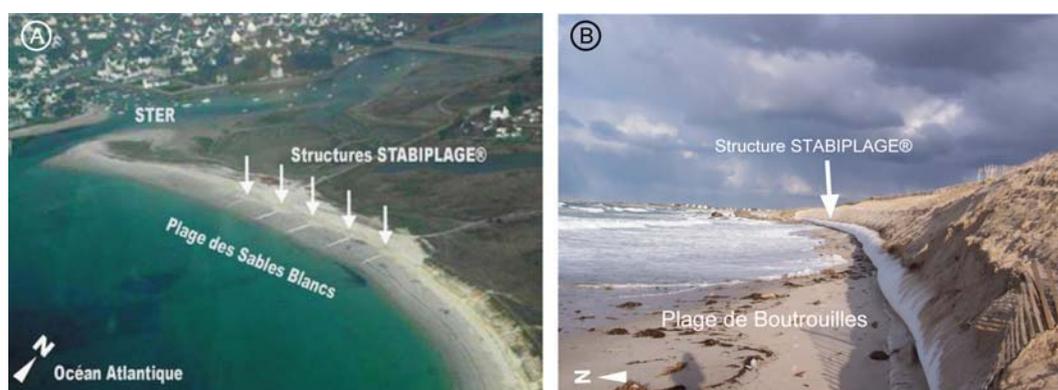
Vue aérienne des 5 STABIPLAGE® transverses mis en place sur la plage des Sables Blancs (A). Vue oblique du STABIPLAGE® implanté en pied de dune sur la plage Boutrouilles (B)
